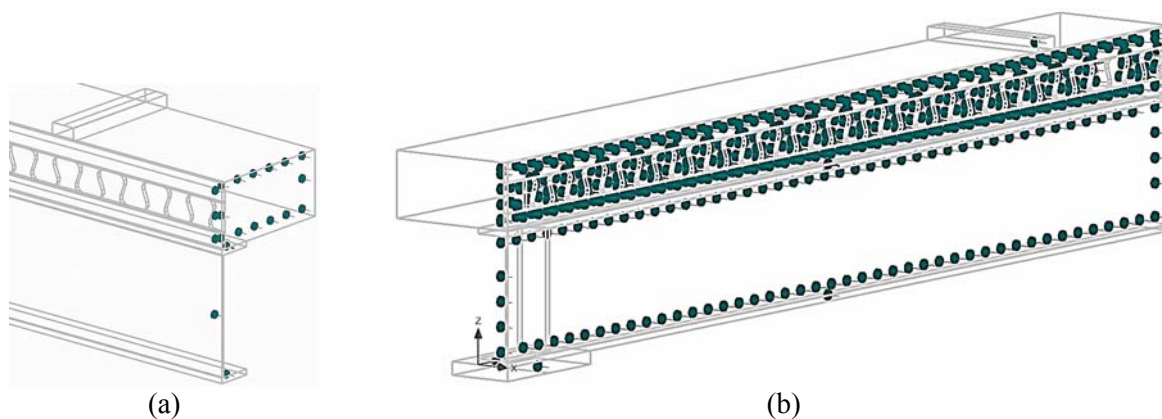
Condições de simetria: (a) Plano transversal de simetria (xz); (b) Plano longitudinal de simetria (yz)
